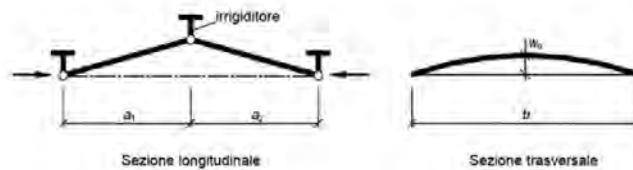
Schema di calcolo per gli irrigiditori trasversali
